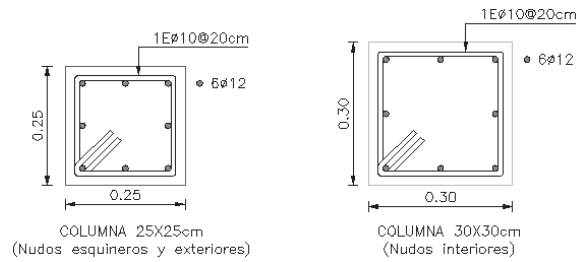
Armadura en columnas (Ejemplo de aplicación)
